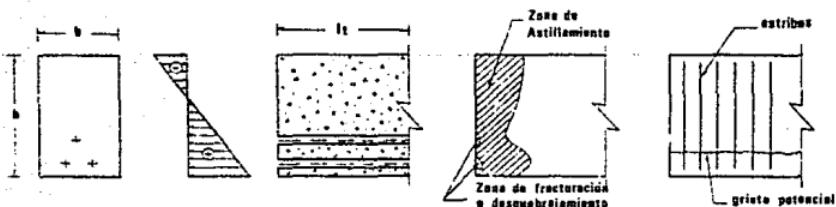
a) Sección transversal de una viga cresterizada. b) Bloques de esfuerzos provocados por la acción horizontal del presfuerzo en el sentido transversal de la viga. c) Transmisión de la fuerza de presfuerzo al concreto. d) Juntas afectadas por la acción del presfuerzo y el desquebrajamiento del alambre o refuerzo rebarro.
